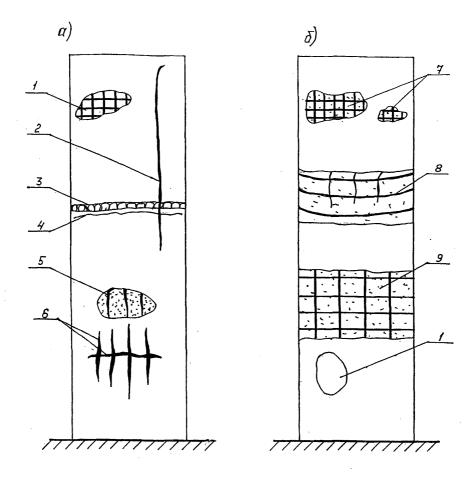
Повреждения стен железобетонных цилиндрических силосов а - наружная поверхность; б - внутренняя поверхность; 1 - бреши; 2 - вертикальные трещины пириной 0,1...3 мм; 3 - смятие бетона в горизонтальных швах бетонирования; 4 - горизонтальная трещина; 5 - выпучивание домкратных стержней; 6 - горизонтальные и вертикальные трещины от перегрузки в области пластических шарниров; 7 - коррозионное разрушение бетона и арматуры; 8 - разрушение защитного слоя бетона от горячего сыпучего материала с провисанием кольцевой арматуры; 9 - истирающий износ защитного слоя бетона
